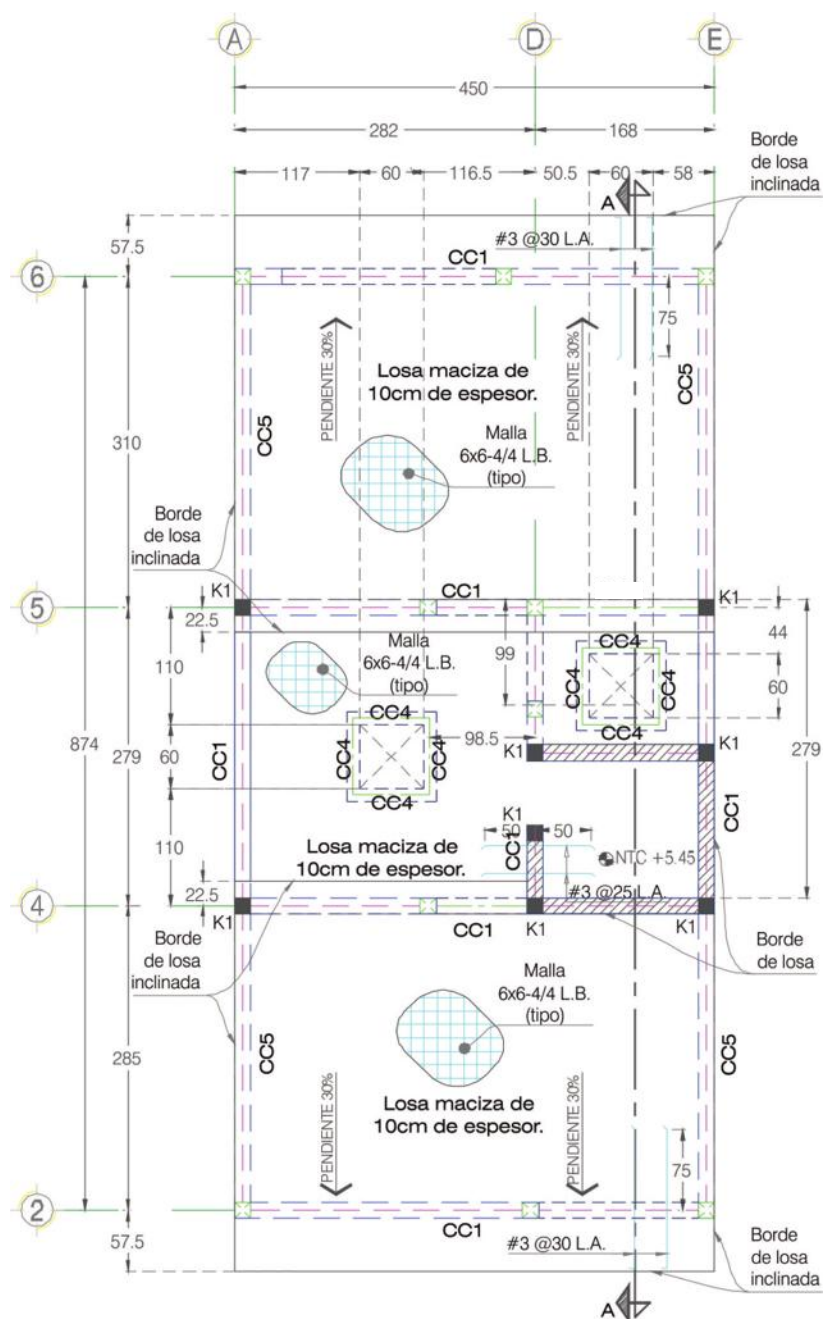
PLANTA LOSA DE AZOTEA (SAUCE).
